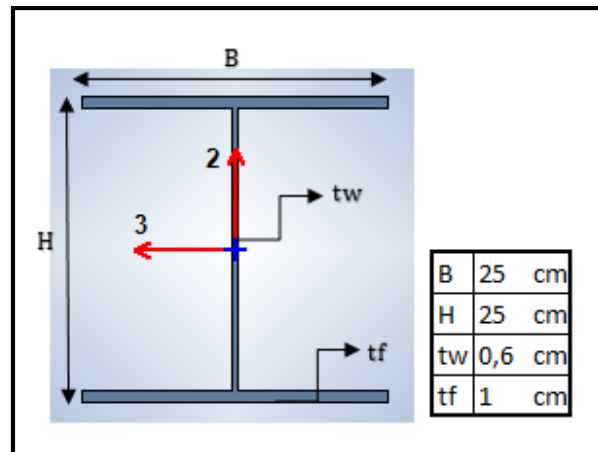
Dimensiones, Columna 3 con pórticos arriostrados diseñados con la NEC.
